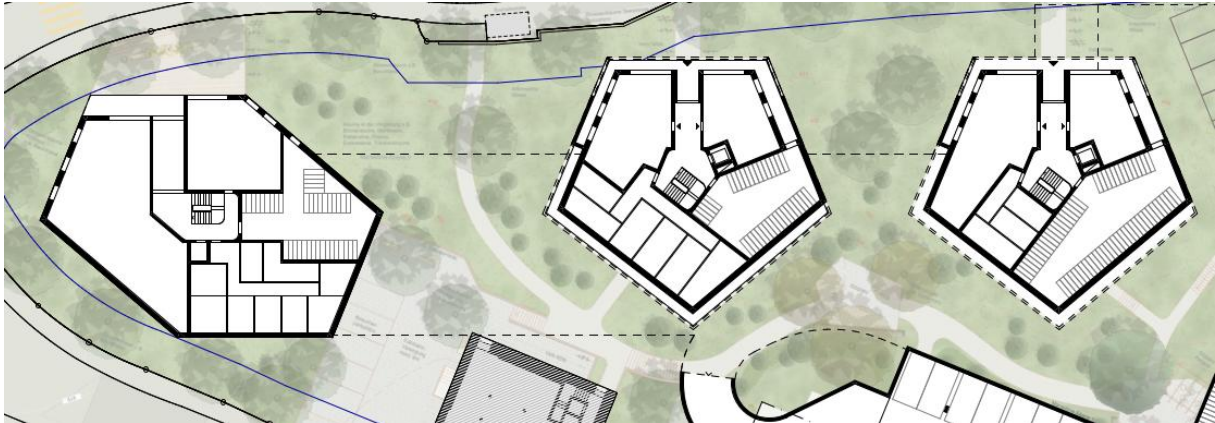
Grundriss Ebene 1 [3]
